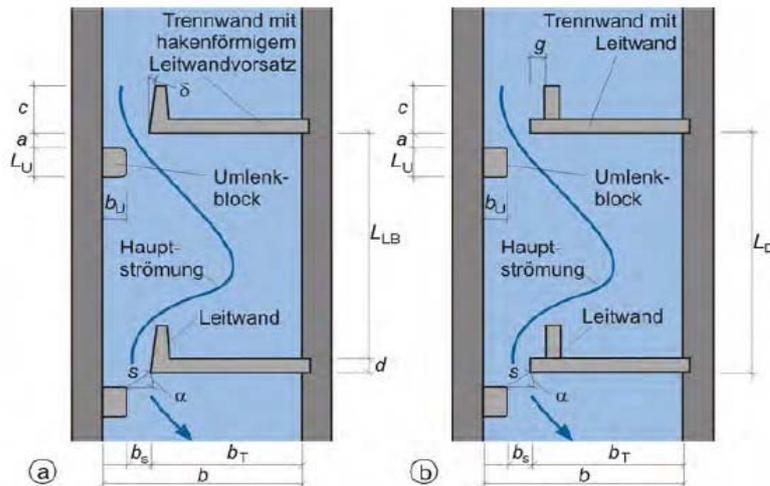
Abmessungen und Bezeichnungen beim Schlitzpass mit einem Schlitz (Grundriss):
